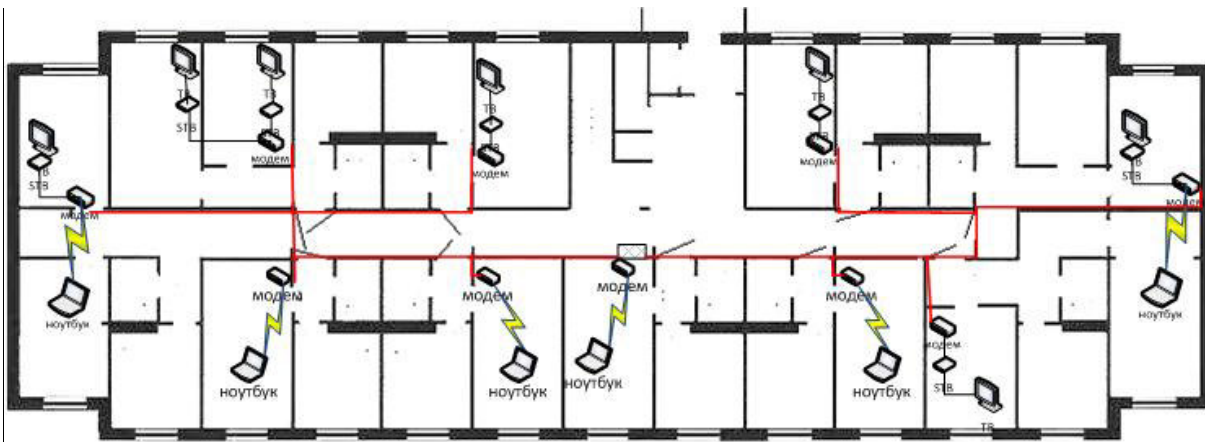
План размещения оборудования доступа в жилом доме
